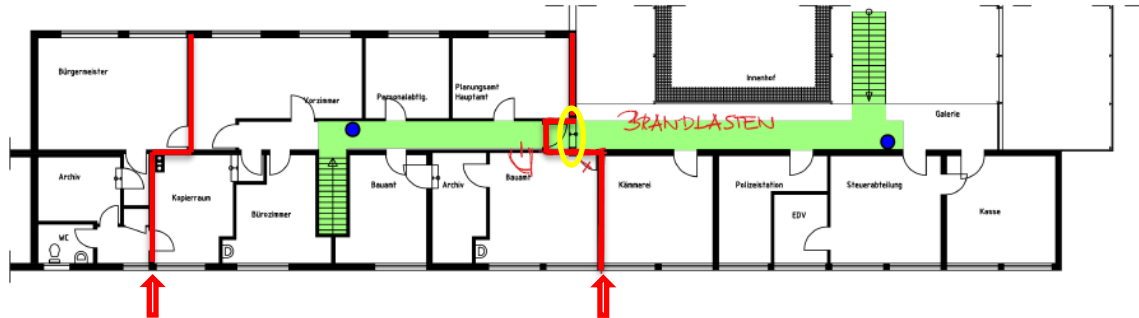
Grundriss OG, aus Flucht- und Rettungswegeplan
